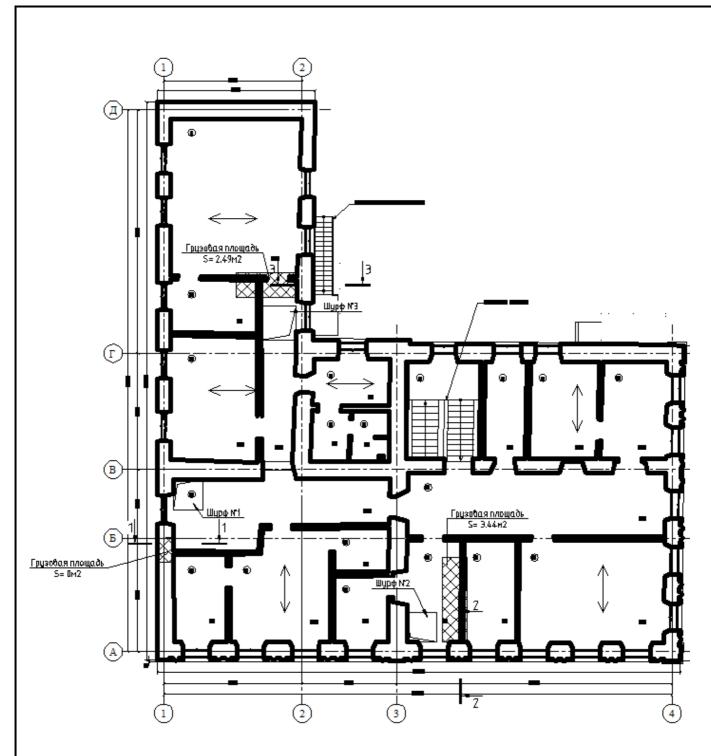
Схема расположения расчетных сечений для сбора нагрузок на фундамент.
